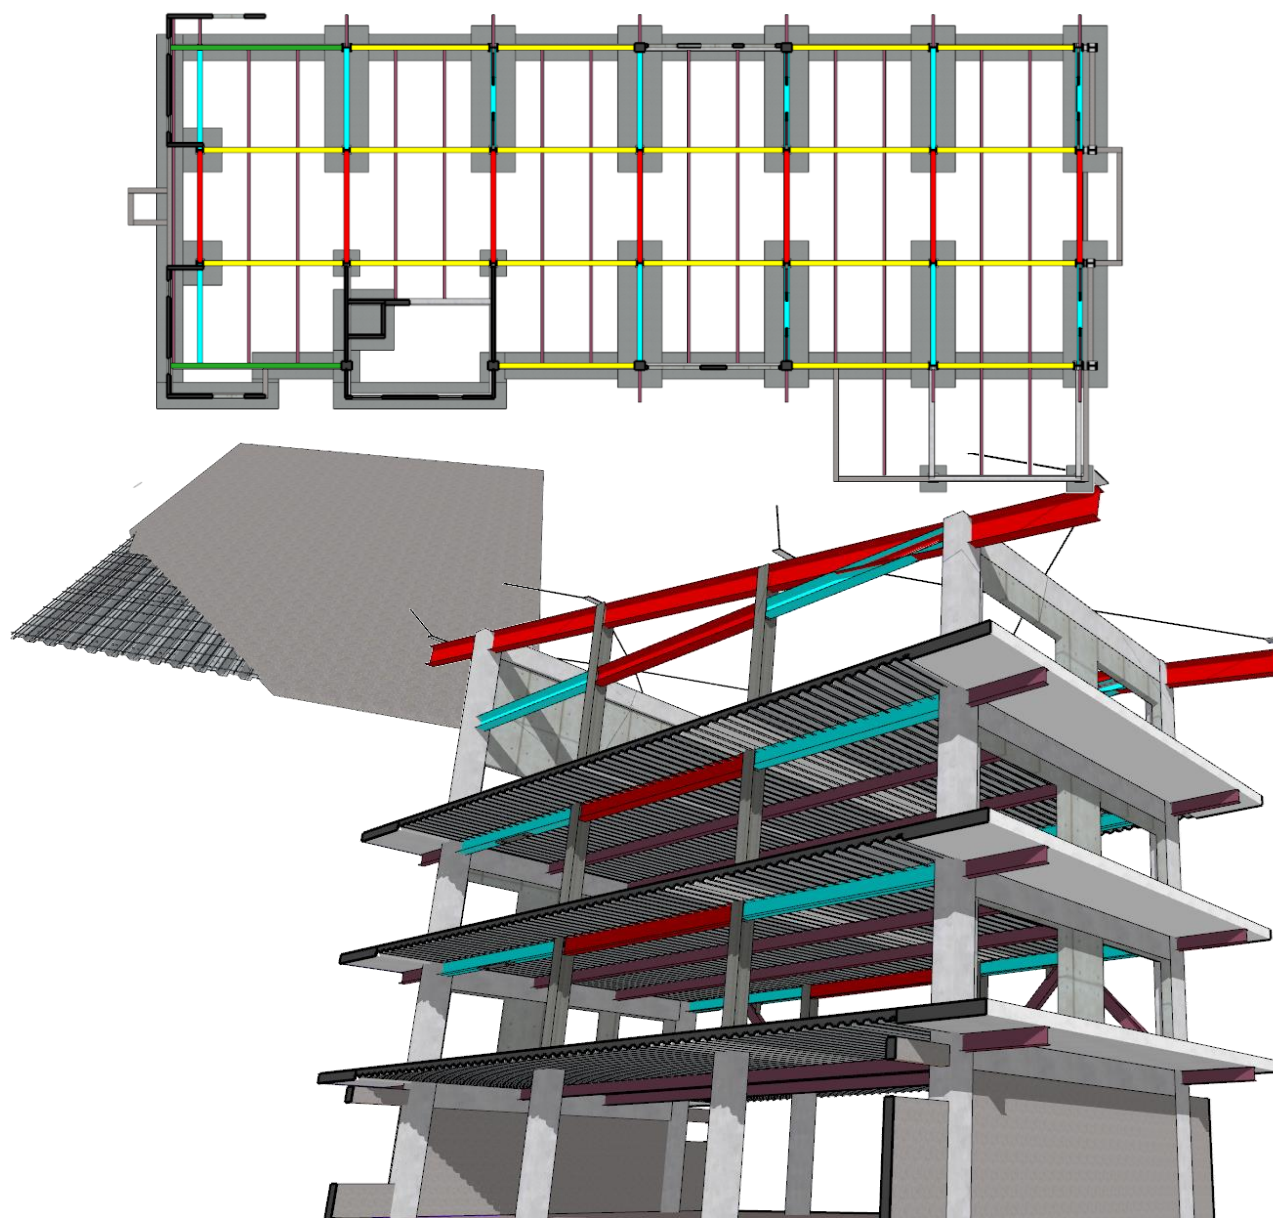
Planta estructural propuesta y modelado 3D de la colocación de la losa METALDECK y las columnas y vigas de acero. Fuente: Elaboración propia
